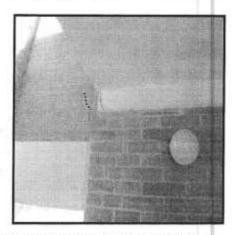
Fisuras de tendencia longitudinal en el espesor de las plaquetas prefabricadas alrededor de la plaqueta colapsada
